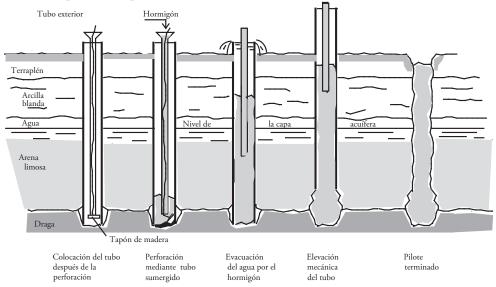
Hormigonado por tubo central de un pilote "in situ" (Gasc, 1971).
